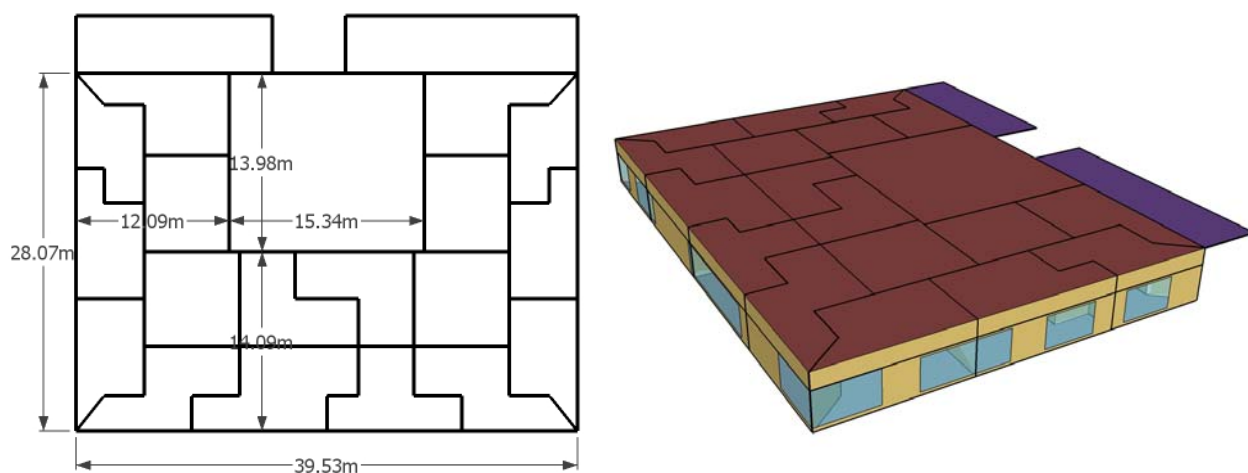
Planta e modelo espacial do Proposed Building para o estudo de caso #5
